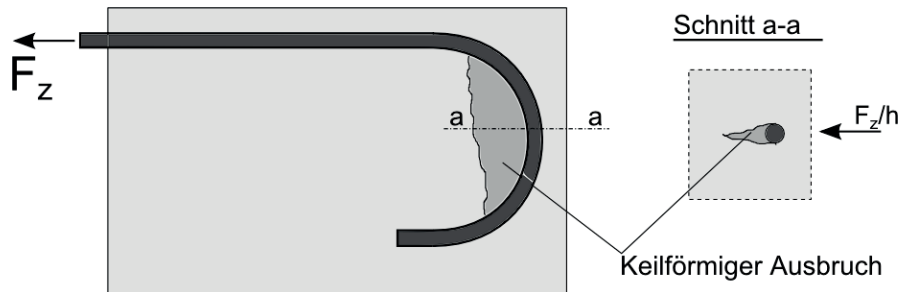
keilförmiger Betonausbruch in einem Rundhaken (Quelle: Foto in *Mörsch 1920*)
